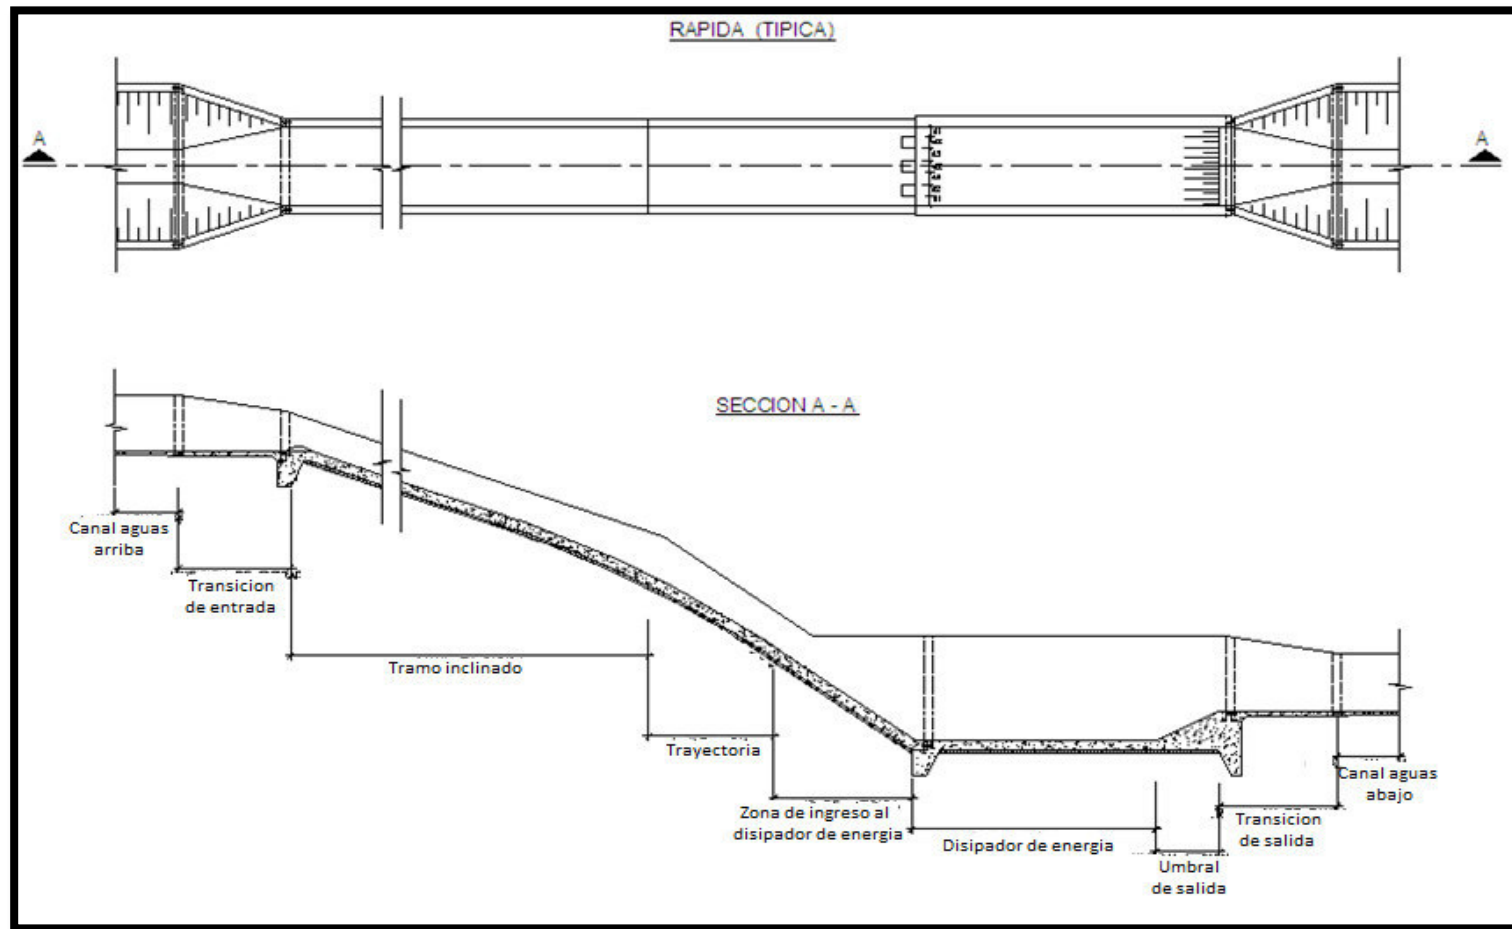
Vista de planta y perfil longitudinal de una rápida en canal abierto
